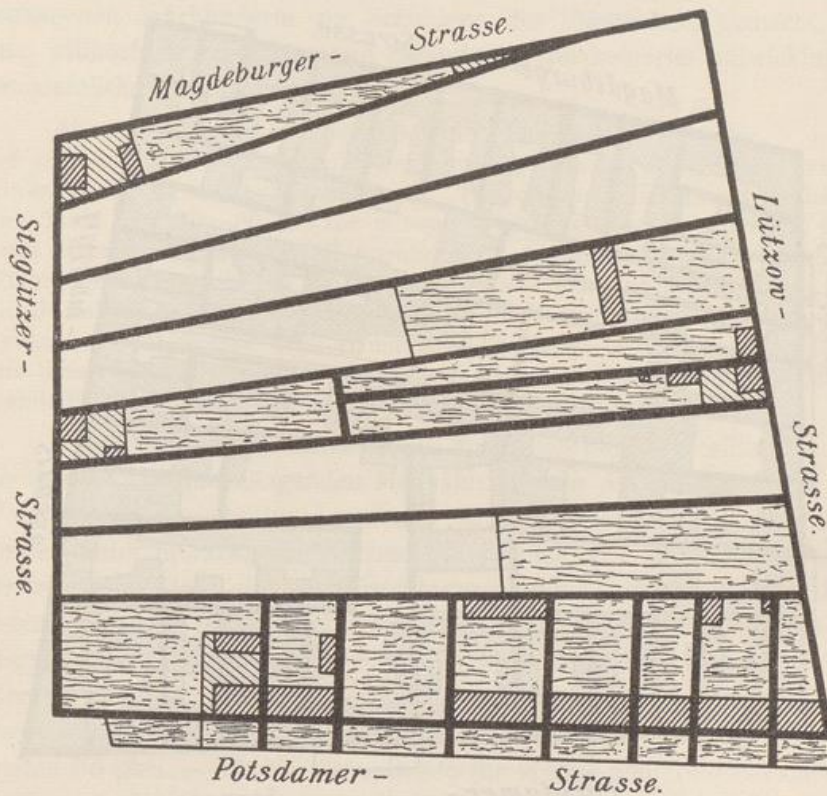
Berliner Baublock im Jahre 1850/51. Maßstab 1:2000.
